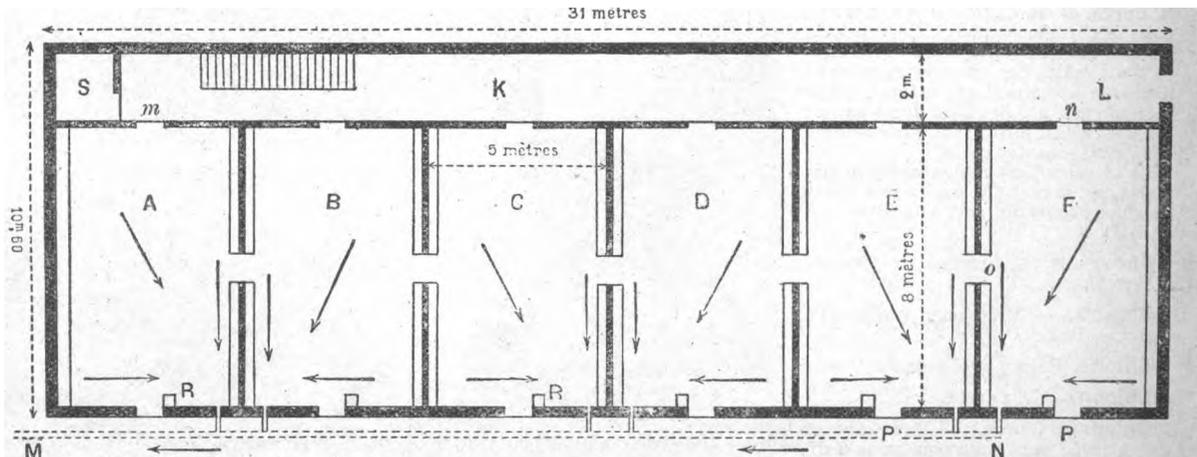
Plan d'une grande chèvrerie de rapport.
